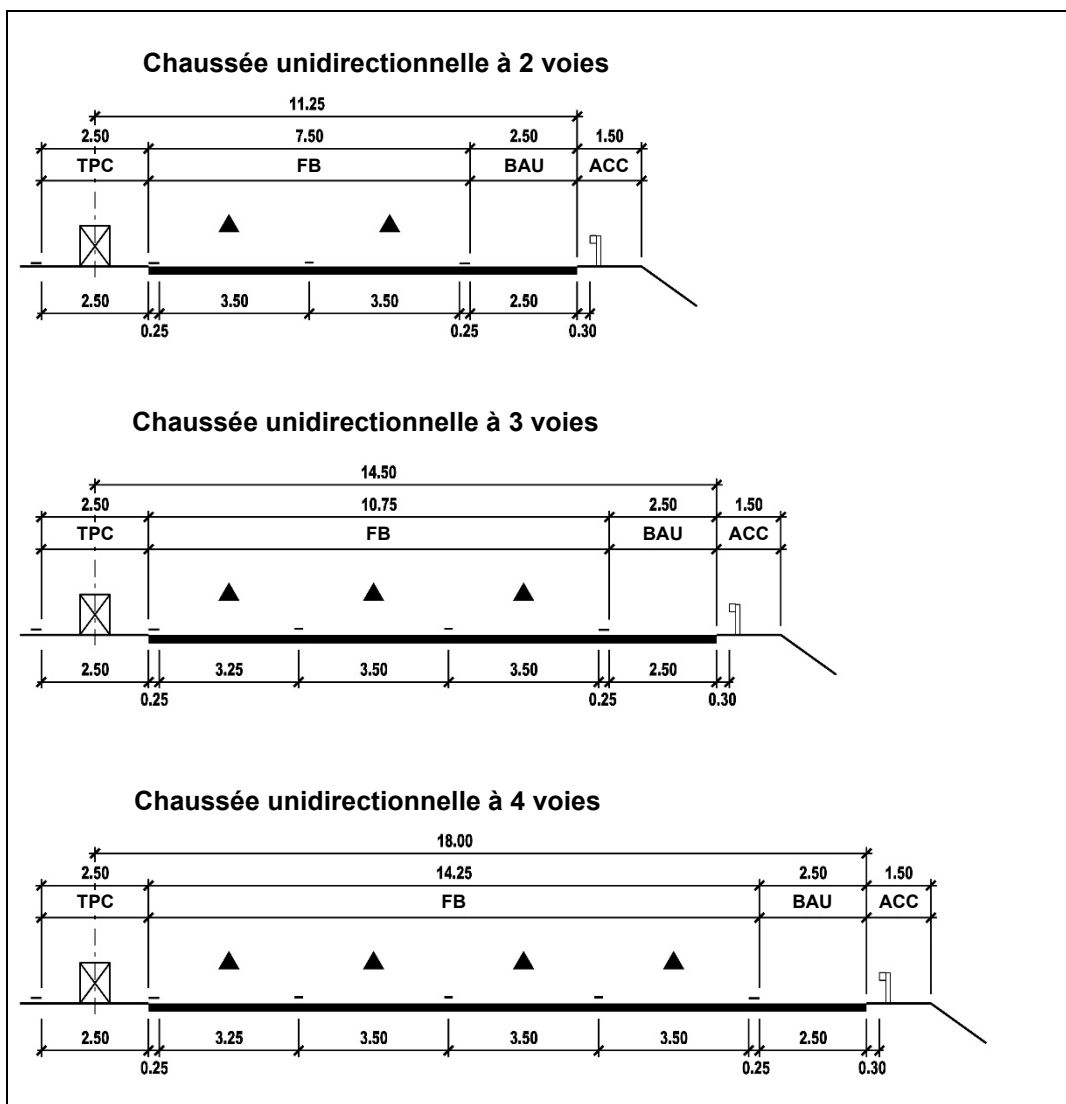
Profils réduits (chaussées unidirectionnelles à 2, 3 et 4 voies)
